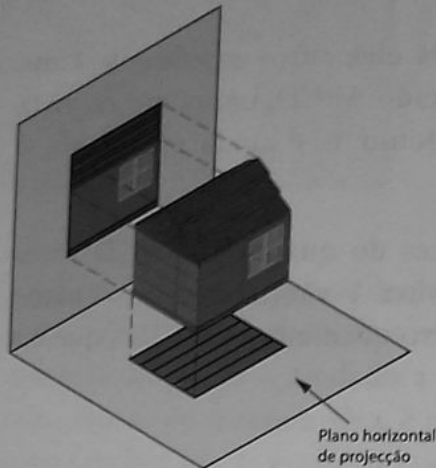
Plano horizontal - onde se projecta a planta do objecto (vista de cima).
